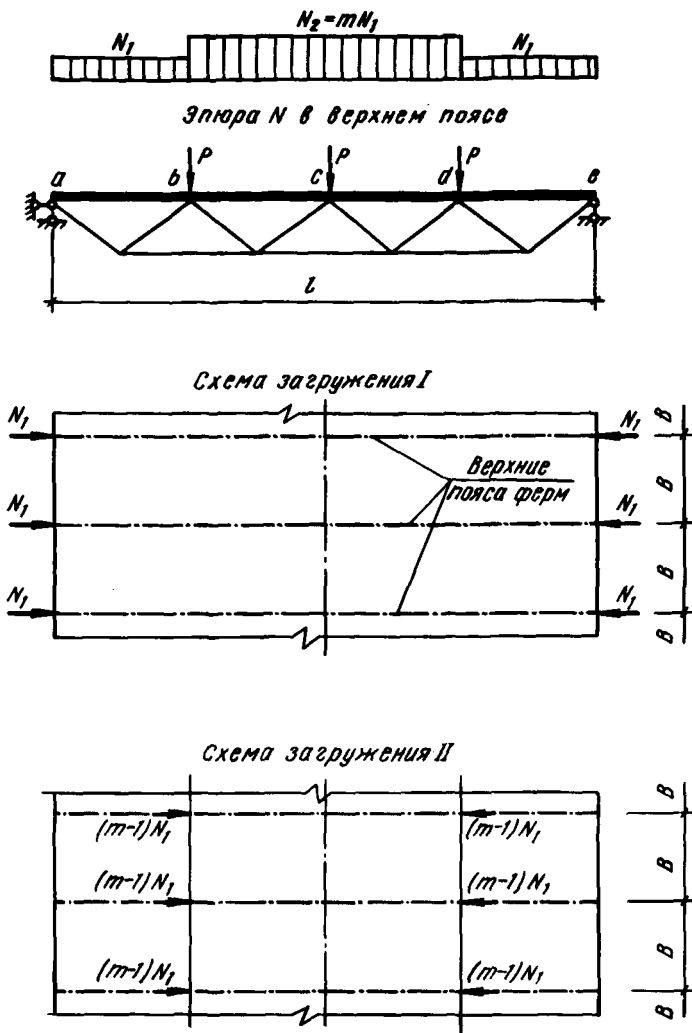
Схемы загрузкиения настила сталежелезобетонных ферм покрытия при определении его напряженного состояния.
